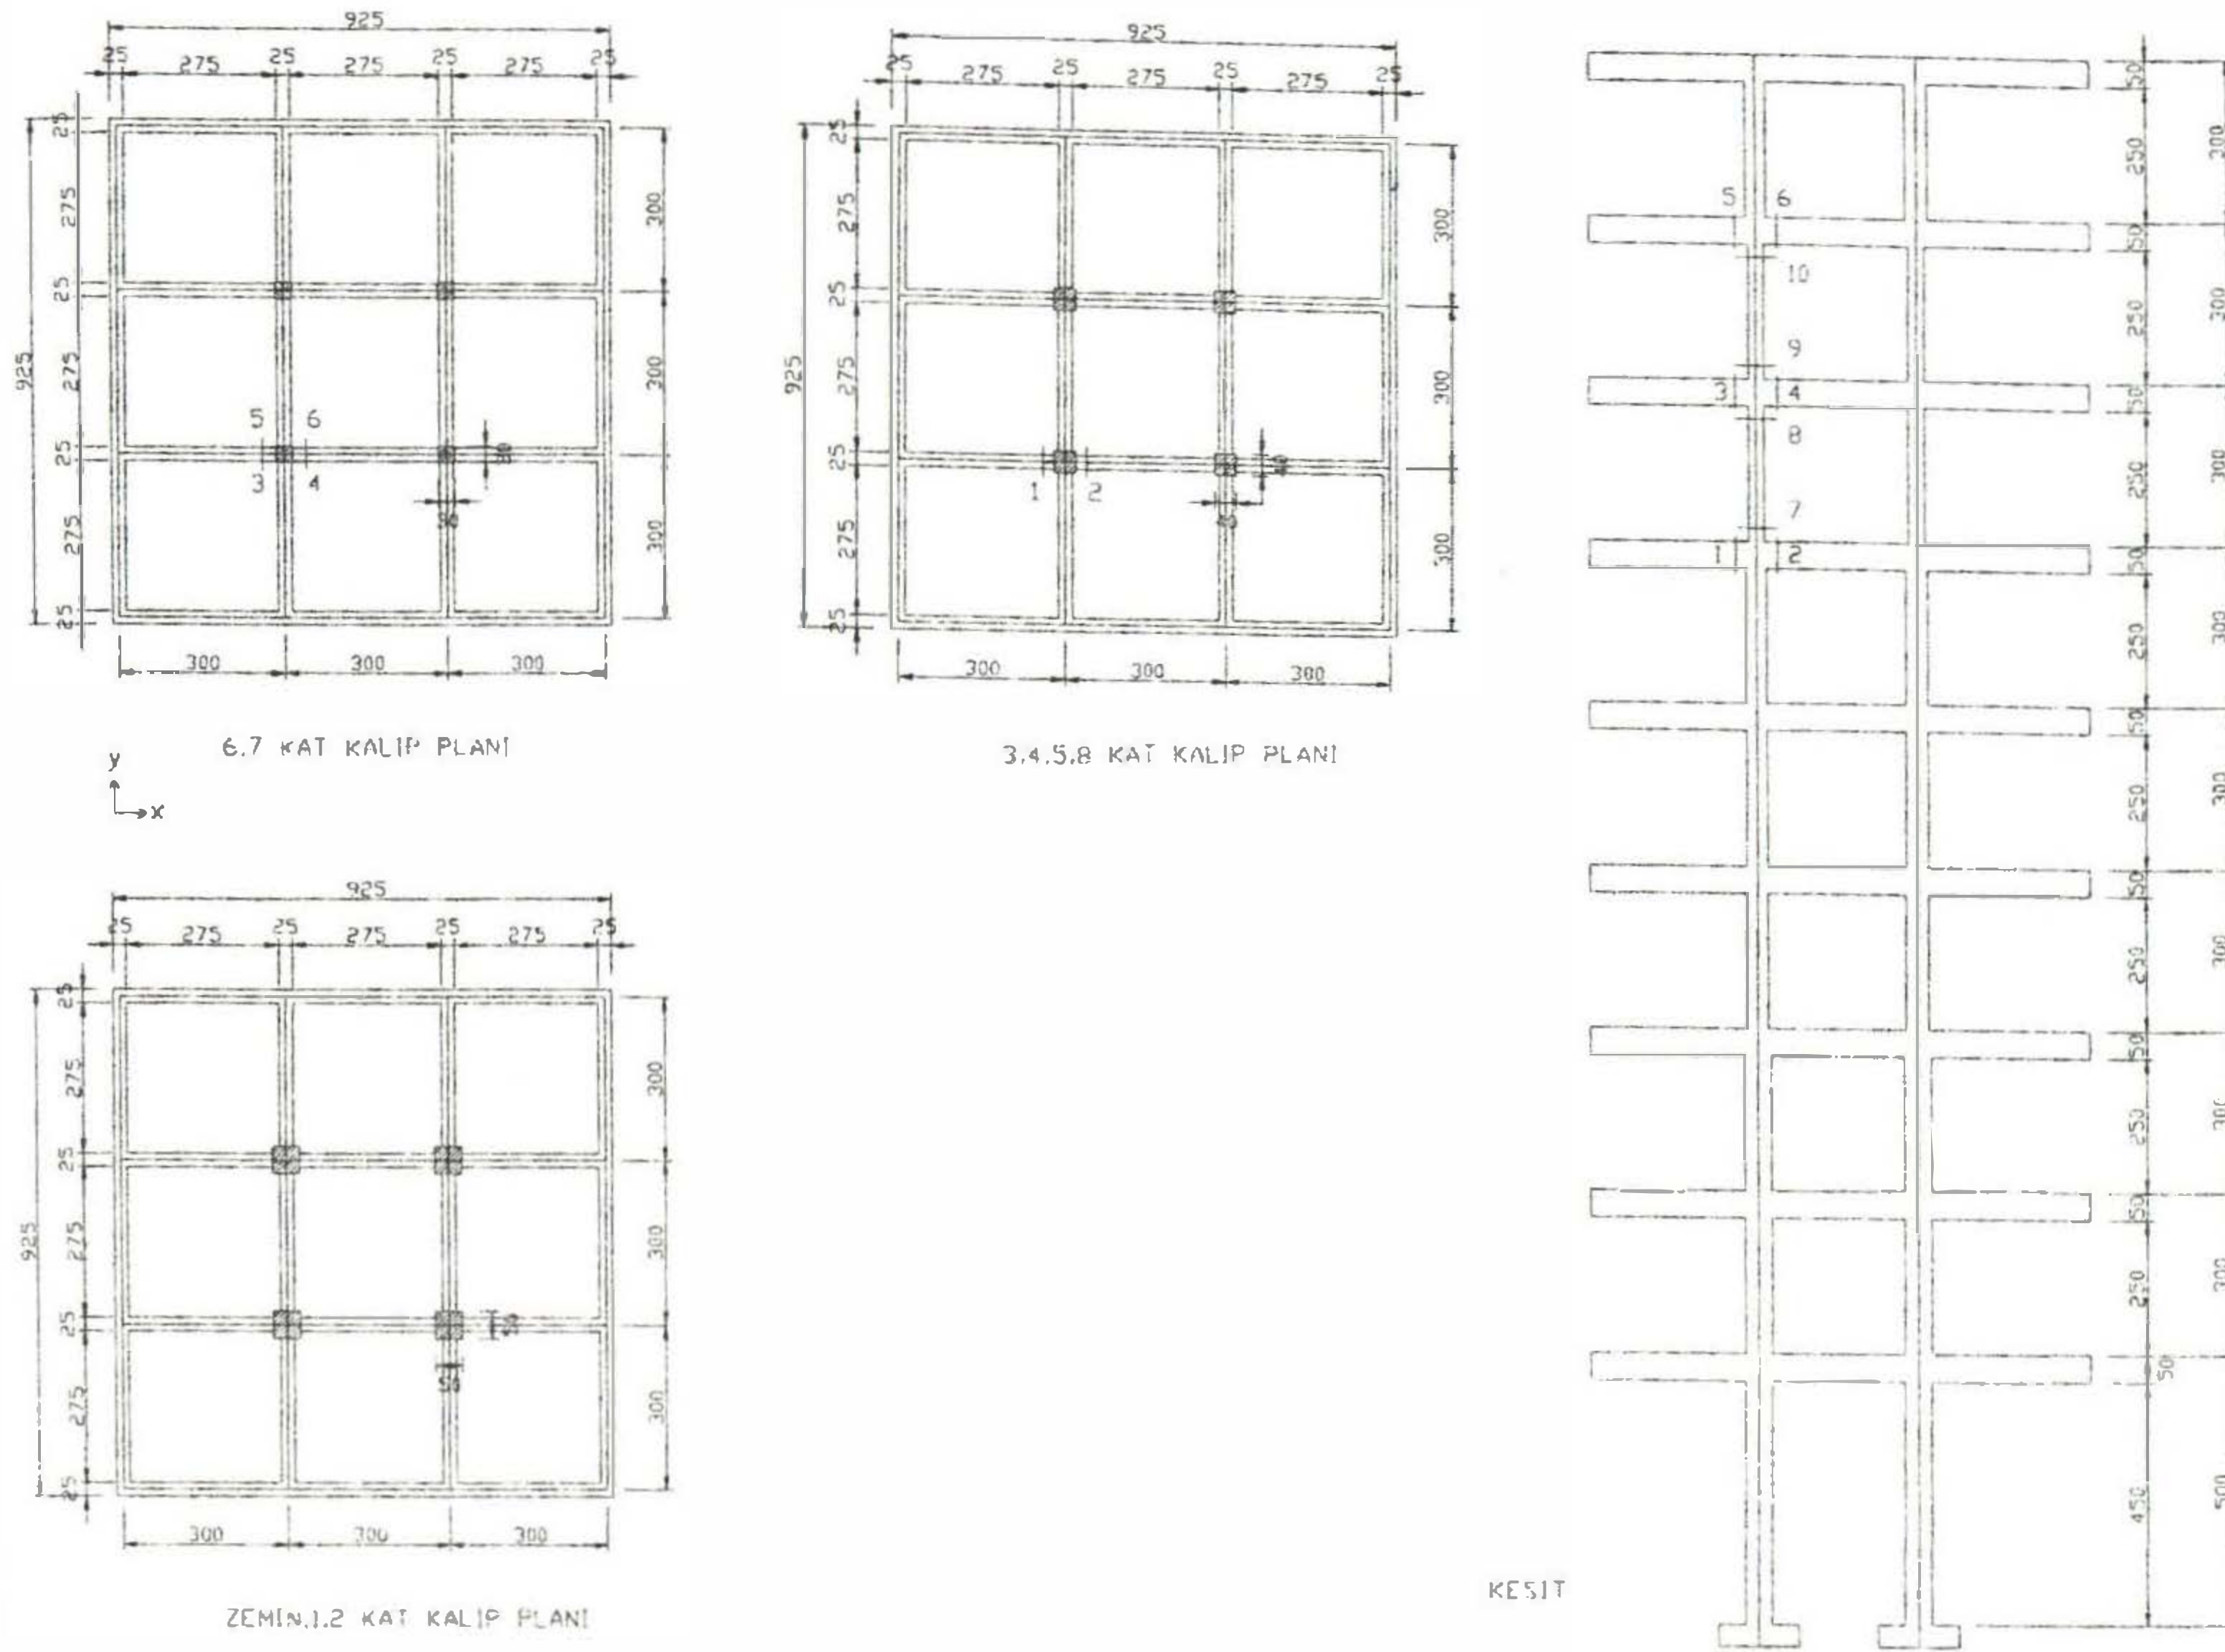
Örnek Yapı – 3 Plan ve Kesit
